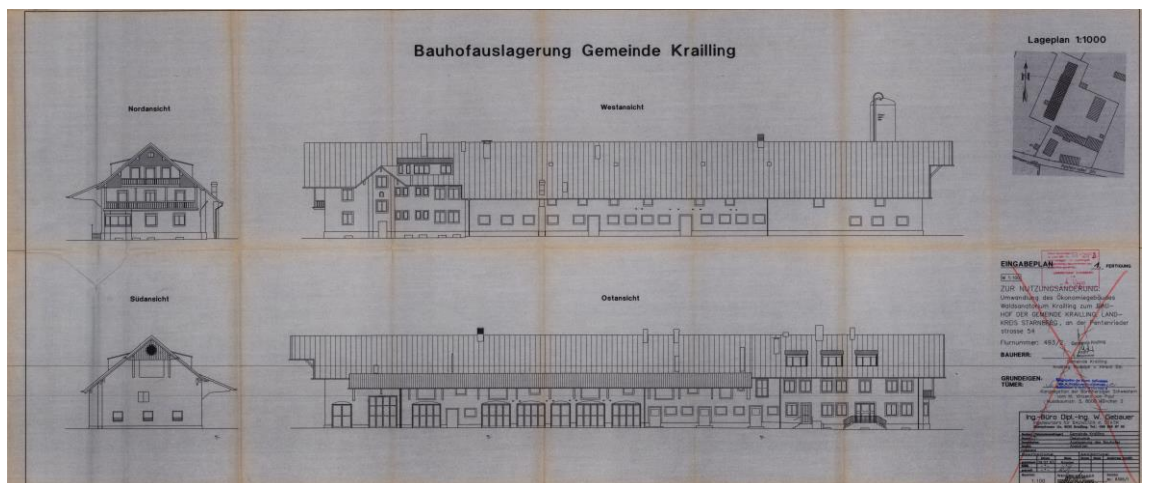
Ansichten zu den Um- und Ausbaumaßnahmen, (Genehmigungsbescheid 24.08.1993) Quelle: Gemeinde Krailling
